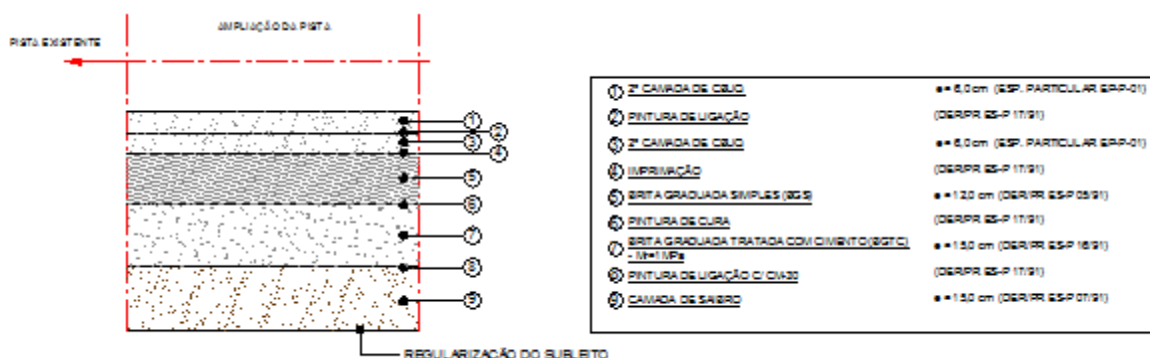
Solução de Pavimento Invertido (Pista a Implantar)
